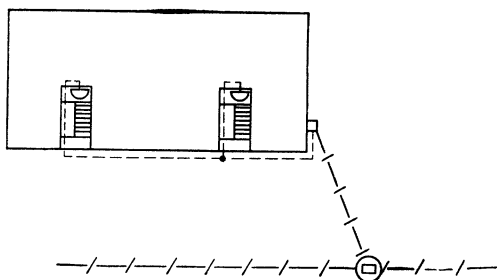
Ввод через чердак от кабеля, подвешенного на канате по стойкам на крышах зданий
